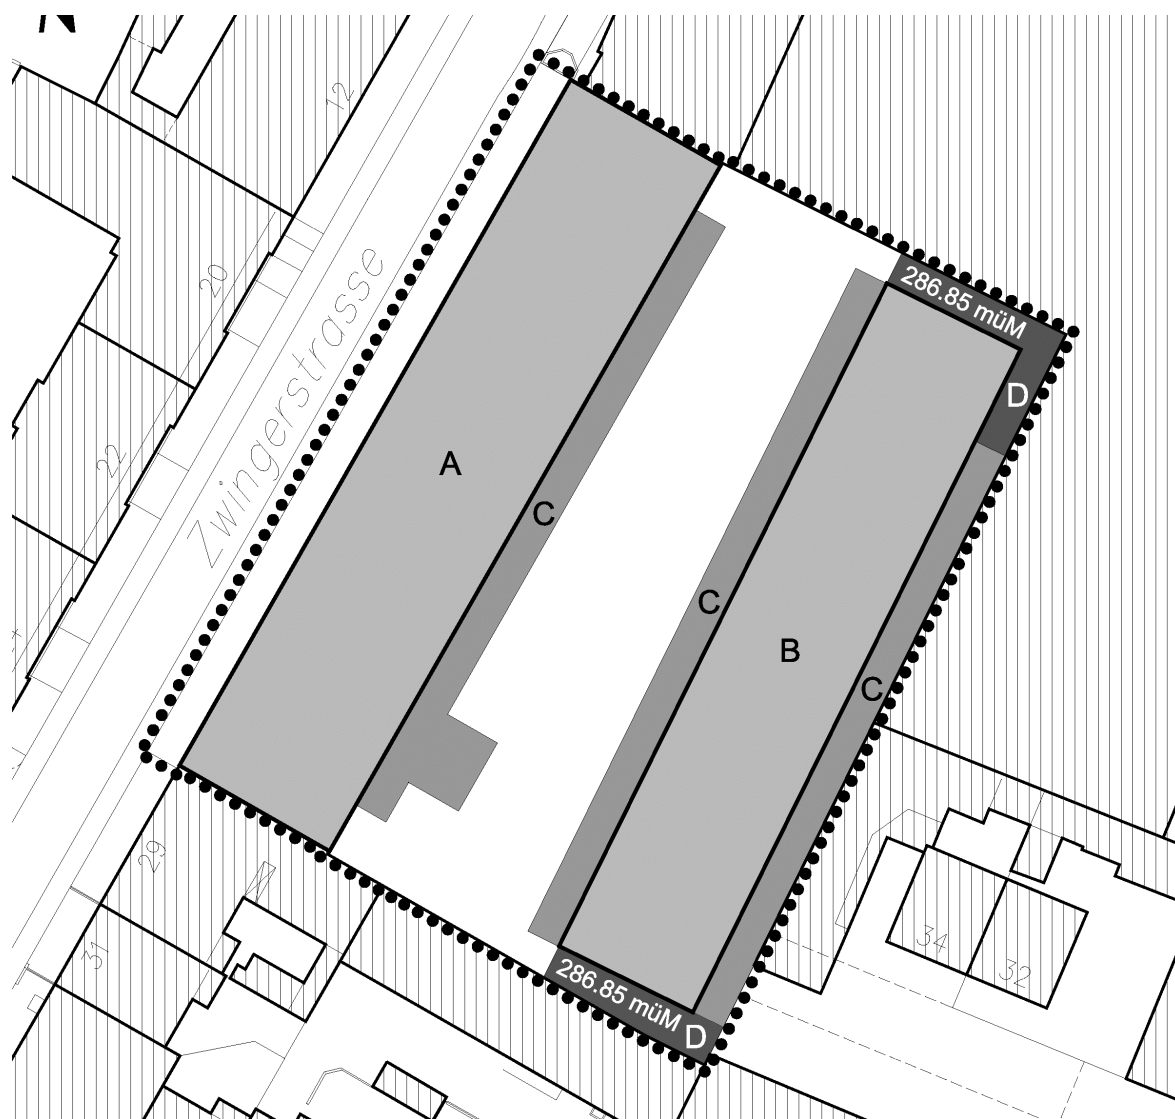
Plan-Nr. 13'189. Bebauungsplan: Situation. (kein Massstab, Plan genordet)
